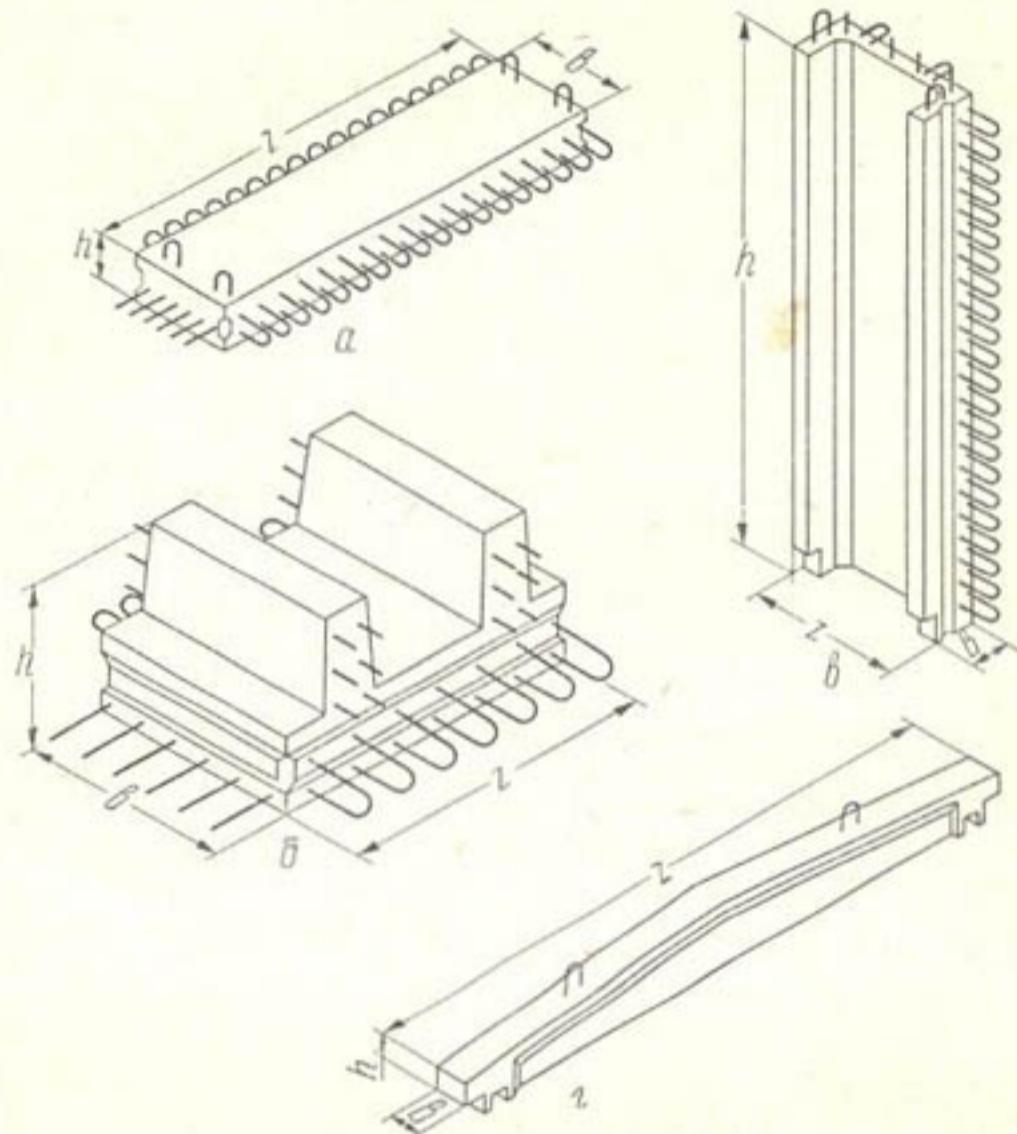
Основные железобетонные элементы здания насосной станции подземного типа:
